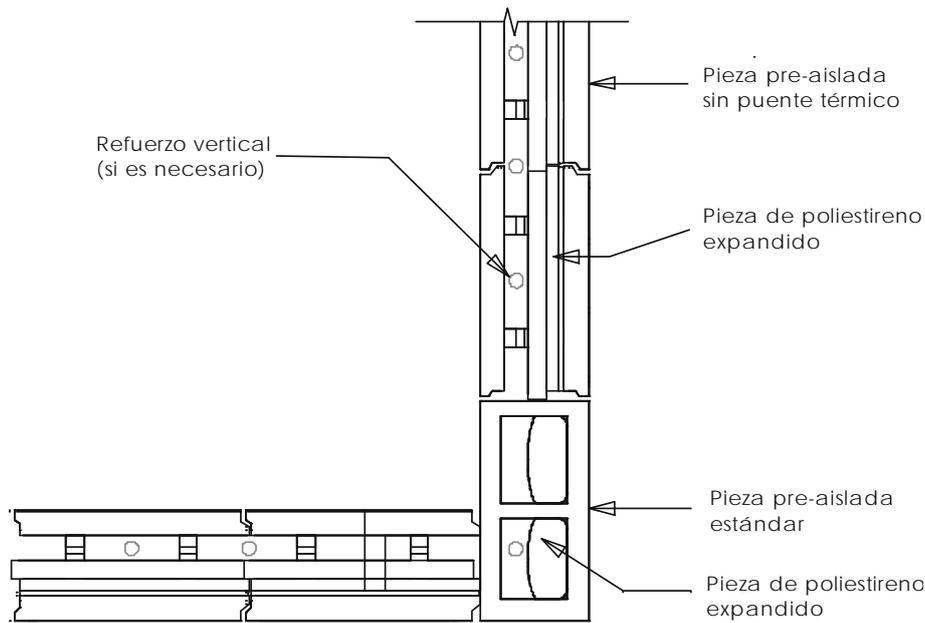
Detalle en esquina con piezas pre-aisladas.
